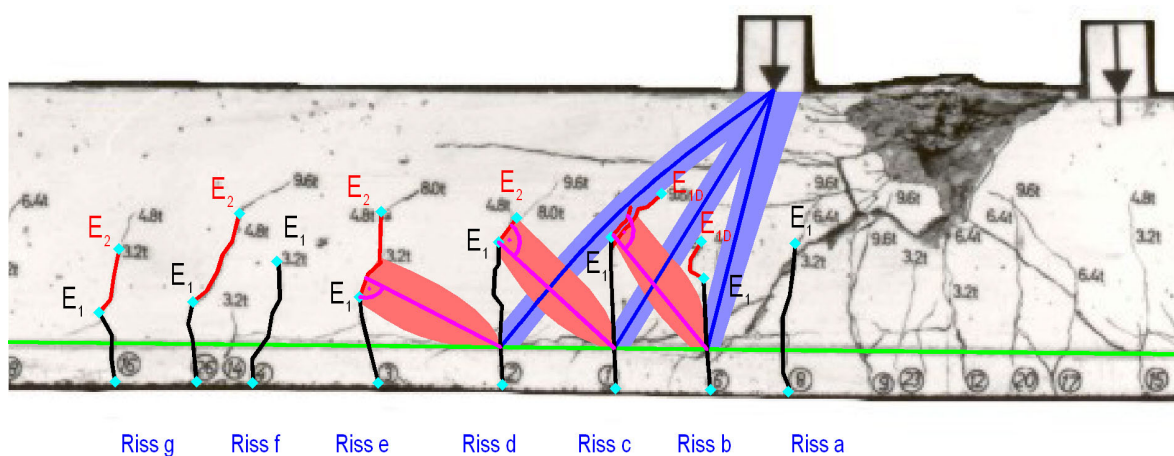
Rissbild des Balkens 10/1 aus [2.4] mit Stegdruck- und -zugstreben im Zustand II.1B_i
